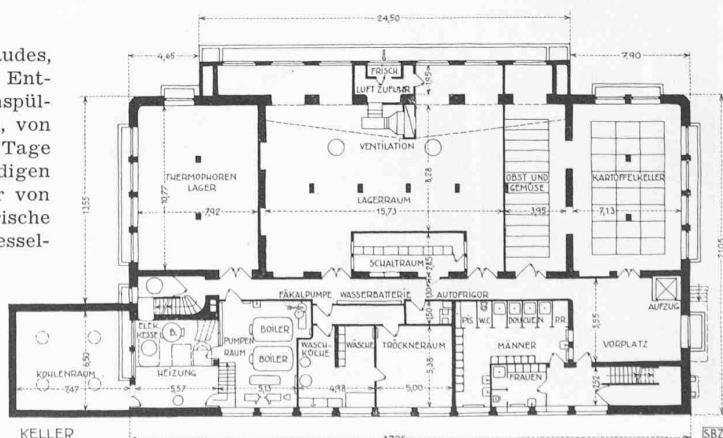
Grundriss vom Untergeschoss — Masstab 1:450
